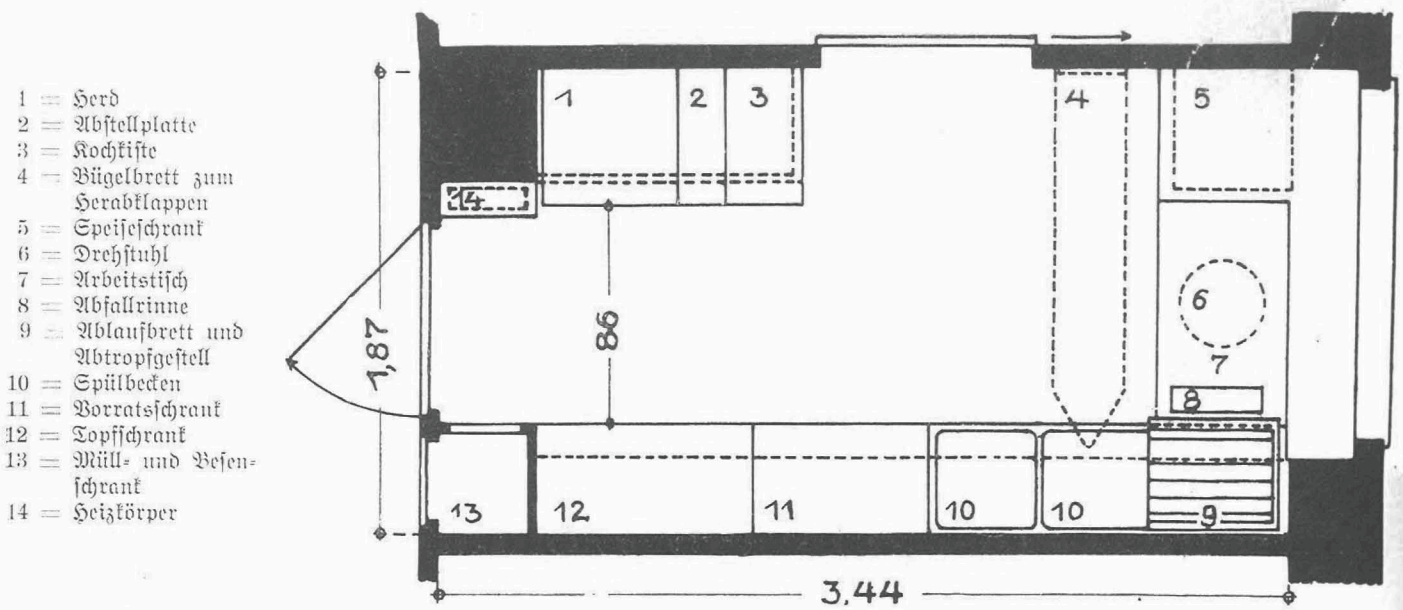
Grundriß der Frankfurter Normenküche für Stockwerkswohnungen. Architektin Grete Lihotky. M. 1:25.
